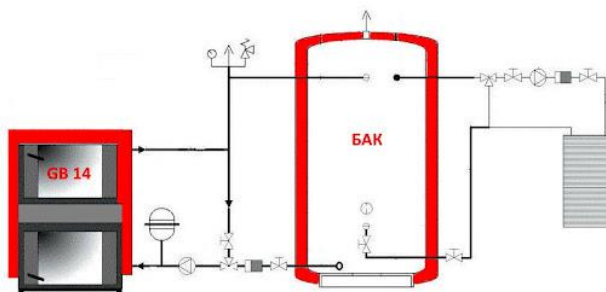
Приклад схеми обв'язки твердопаливного котла
